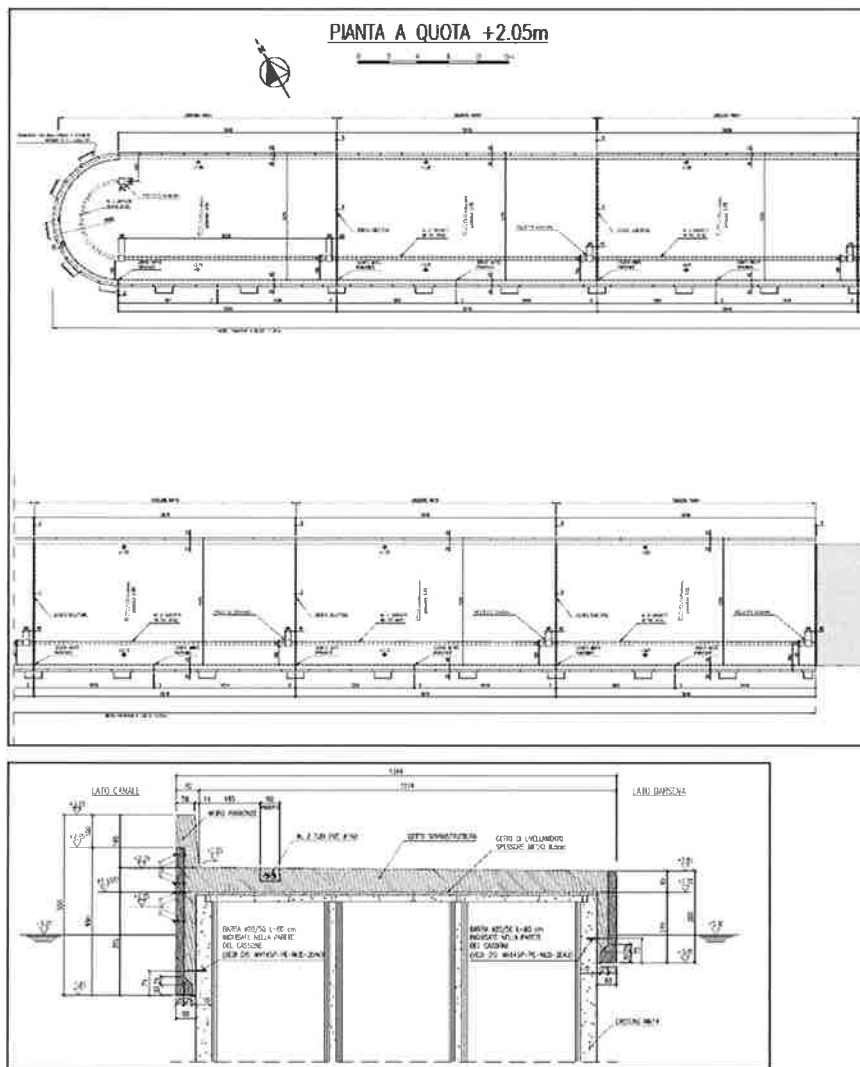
SPALLA NORD, PIANTE E SEZIONE DELLE OPERE DELLA QUINTA WBE DELLA SPALLA NORD
